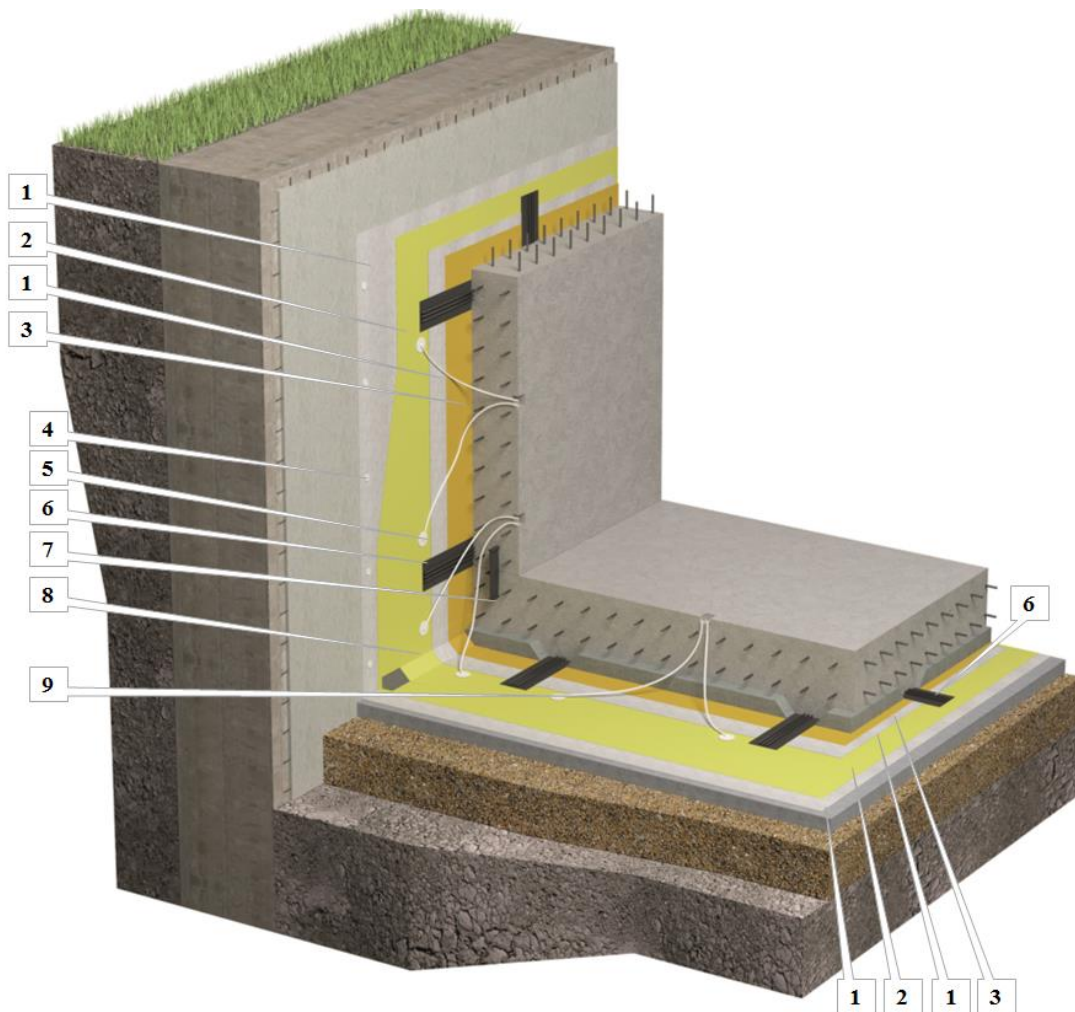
Конструкция гидроизоляционного покрытия транспортных тоннелей открытого способа производства работ при примыкании несущей конструкции тоннеля (обделки) непосредственно к ограждающей конструкции котлована без доступа к наружным поверхностям ограждающих стеновых конструкций.
